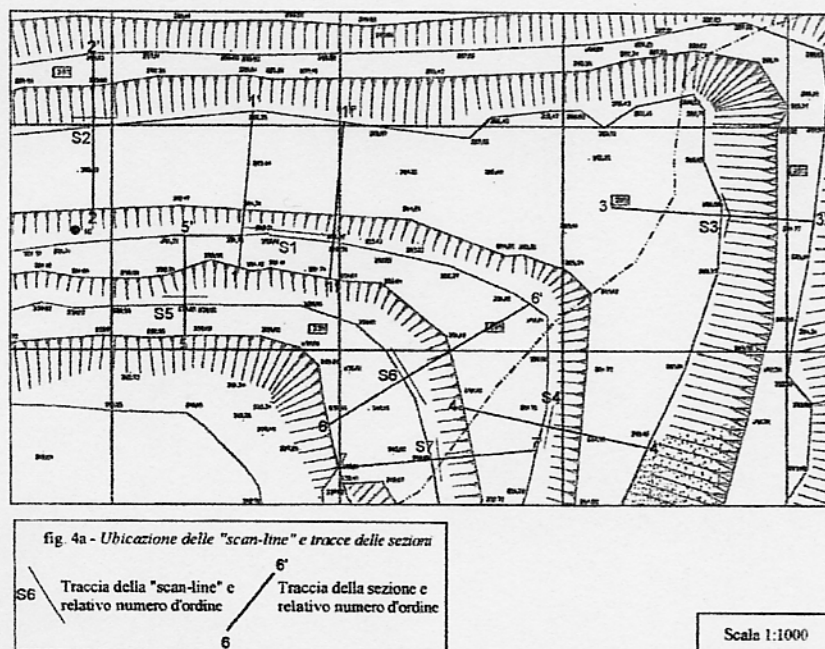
da "Tesina" – Gualdi – Relatore Prof. Ing. Paolo Berry.
